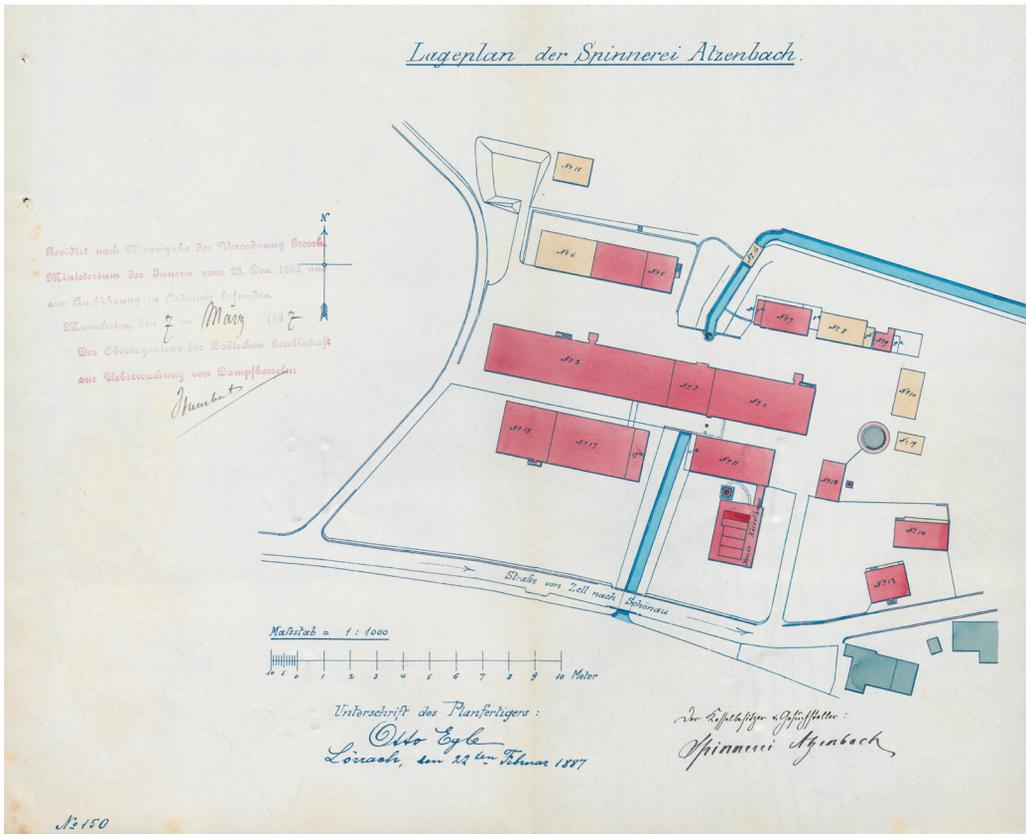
Der Situationsplan der Spinnerei Atzenbach aus dem Jahre 1887 zeigt den Hauptbau, umgeben von Nebengebäuden, darunter die Gasbereitungsanlage mit Gasometer (kreisförmiger Grundriss). StAF B 738/1, Nr. 82.
